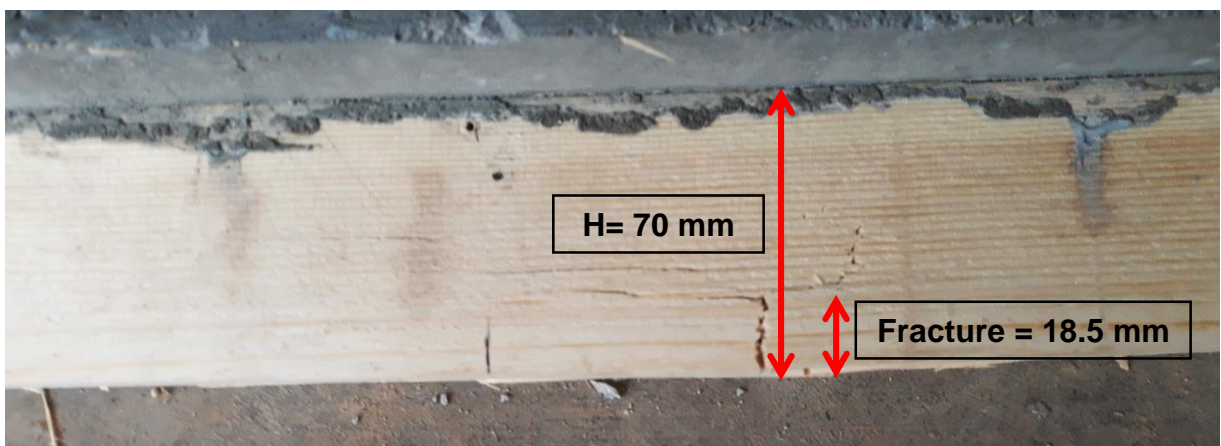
Rupture par traction par flexion de la poutre mixte S+s.
